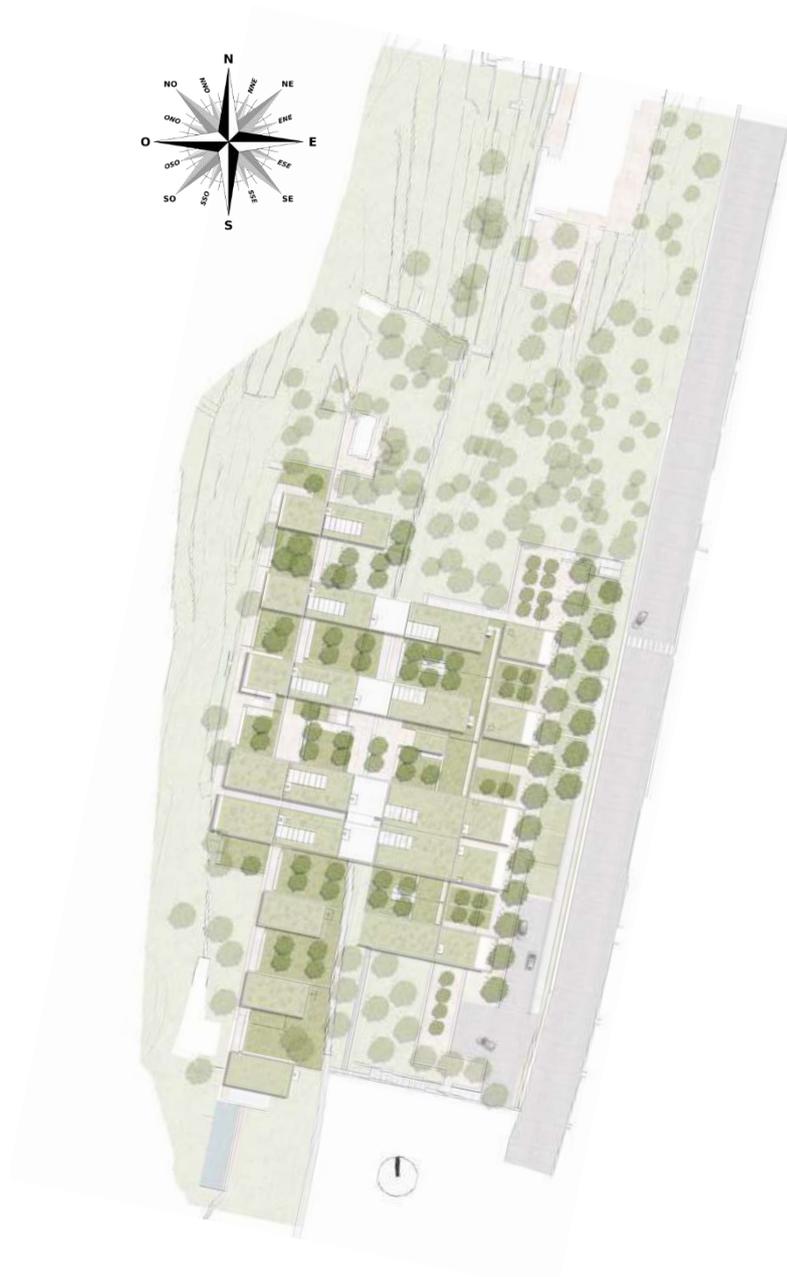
Schéma du plan d'aménagement du projet (source CAB Architectes)
